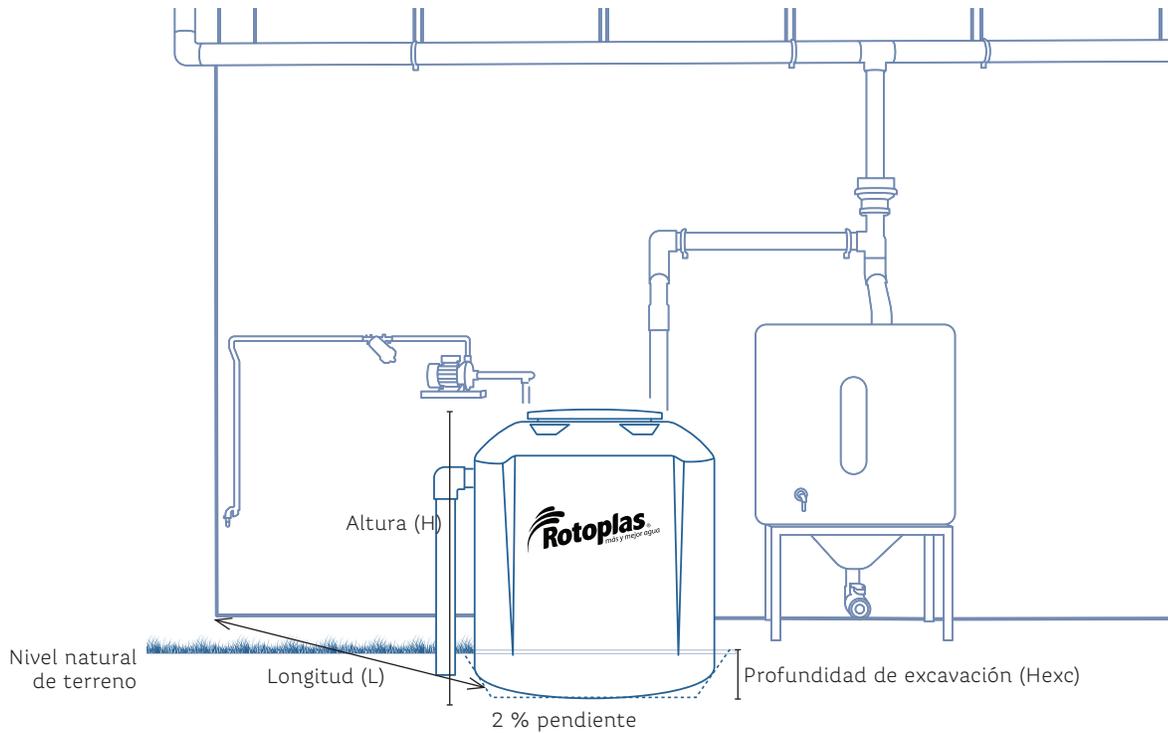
Dimensiones para la excavación e instalación del Tinaco.
